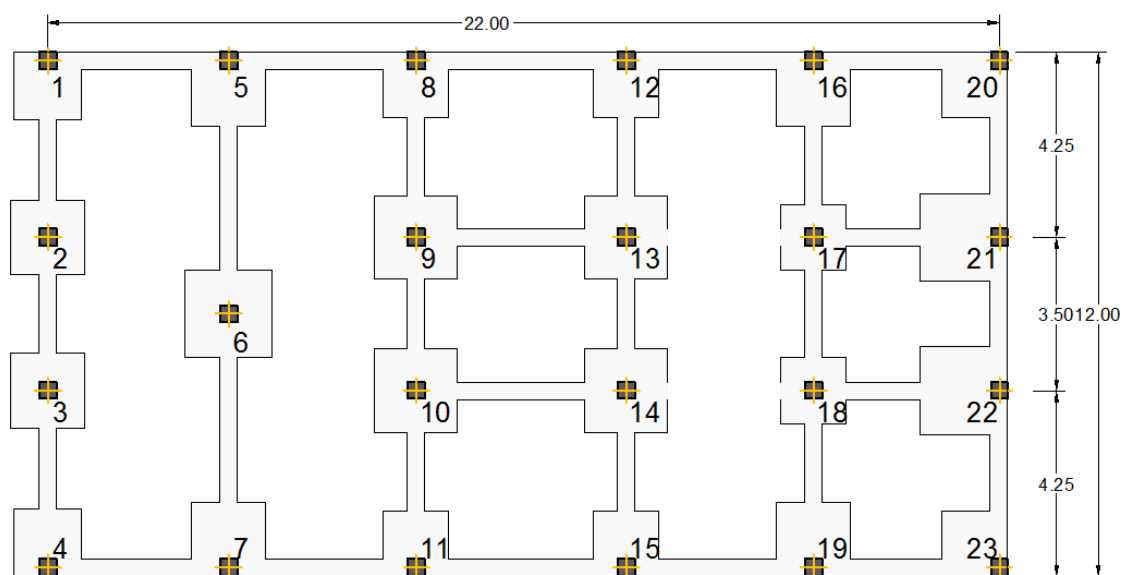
j Esquema planta cimentaciones arquetipo III
